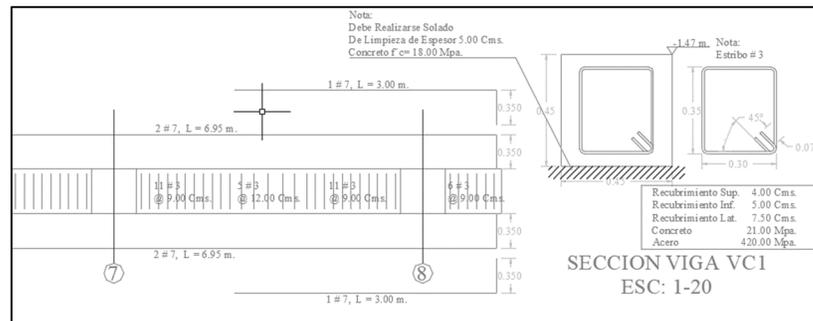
, Viga eje A, C y F, fuente: Constructora Open House.
